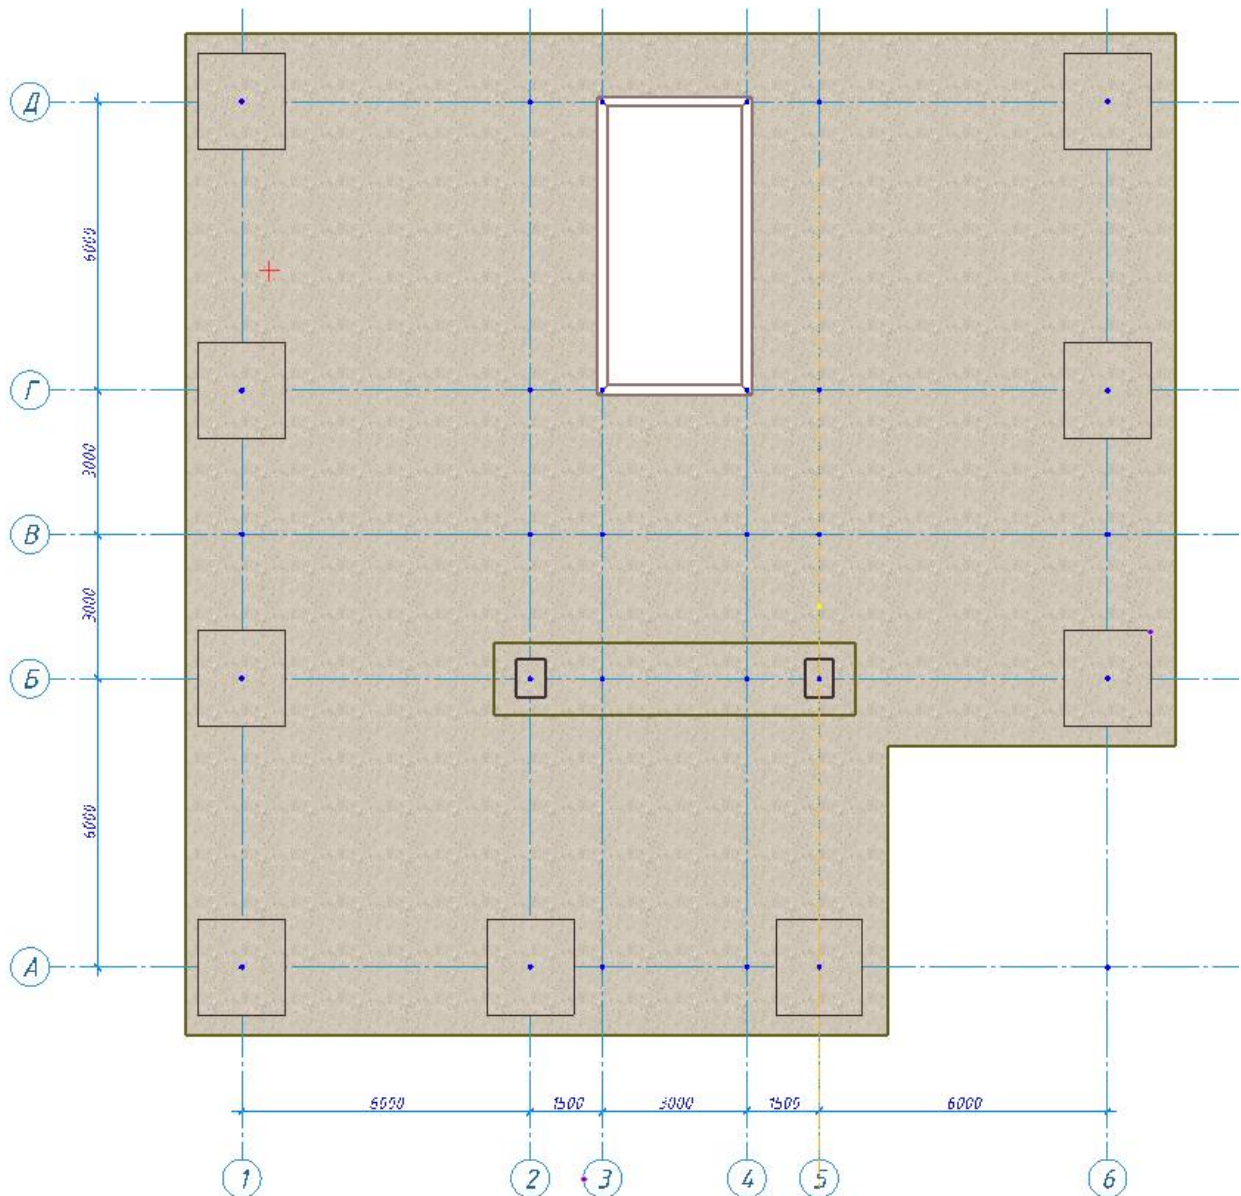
Розташування потовщення в плиті перекриття на виді зверху
